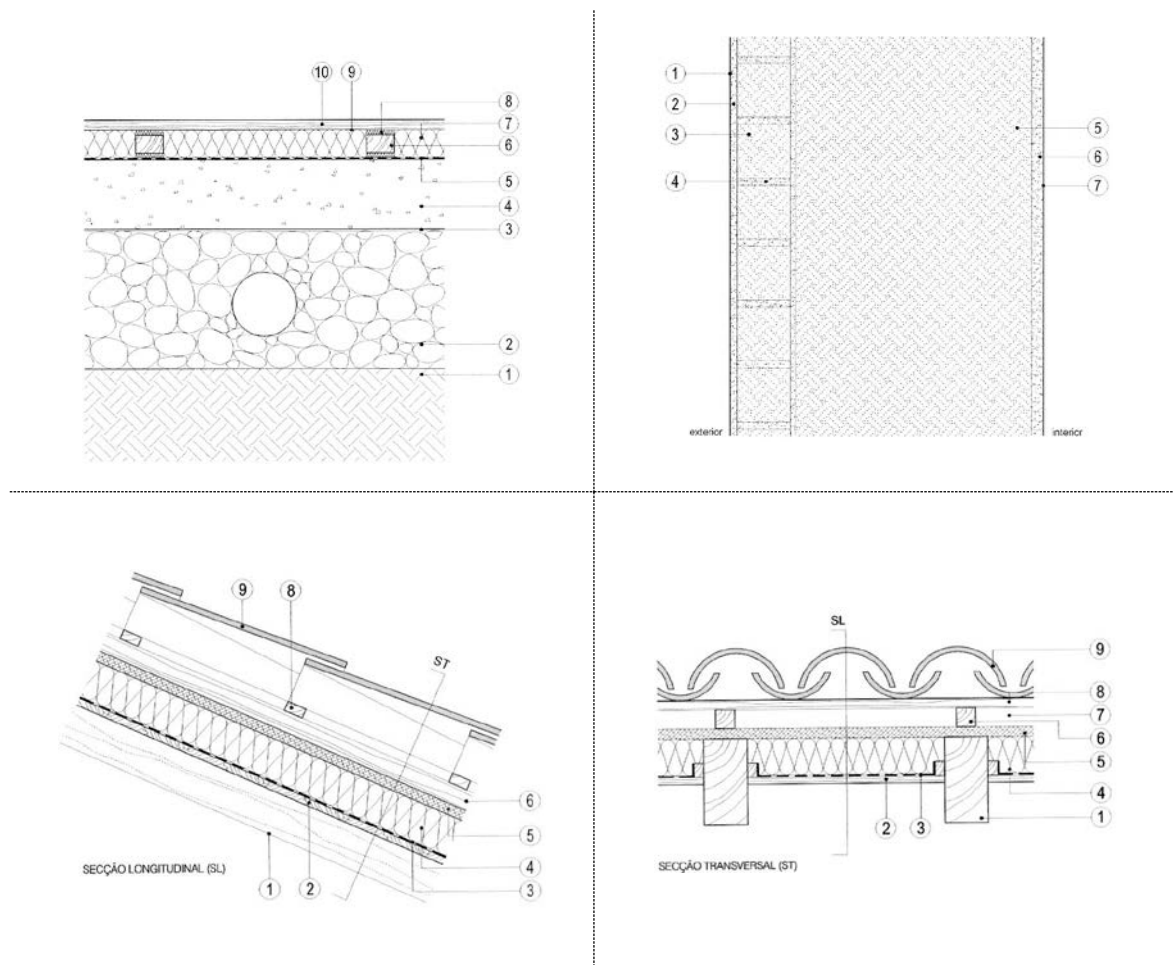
Exemplos tipo de pavimento interior térreo (secção vertical), de parede exterior (secção vertical) e de cobertura inclinada (secções longitudinal e transversal); sem escala
